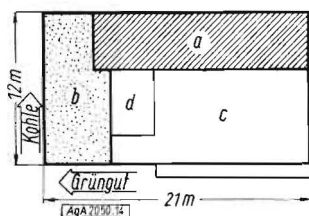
Gebäudeplan bei Verwendung eines Steilförderers
